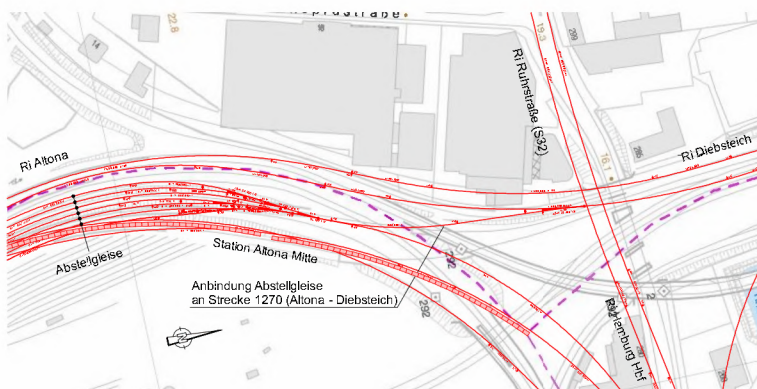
Lageplan Anbindung Abstellgleise an Spange
